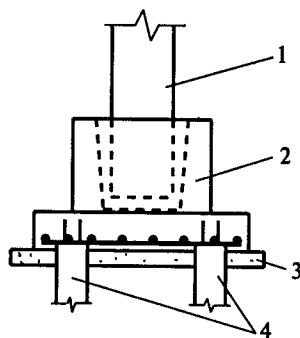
Свайный фундамент под сборную железобетонную колонну:
